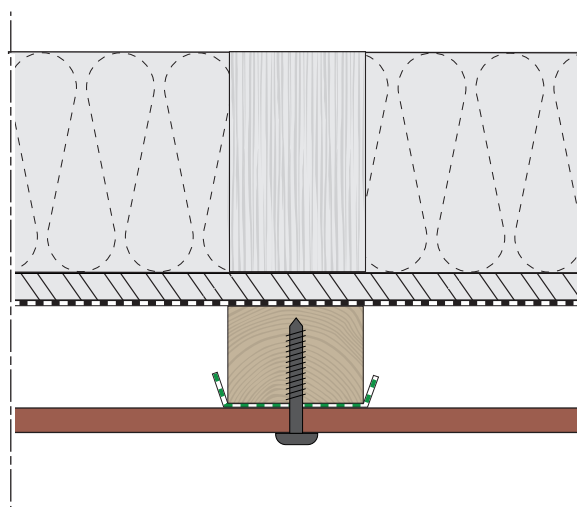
Exemple de point fixe - fixation par vis sur tasseau - coupe horizontale
